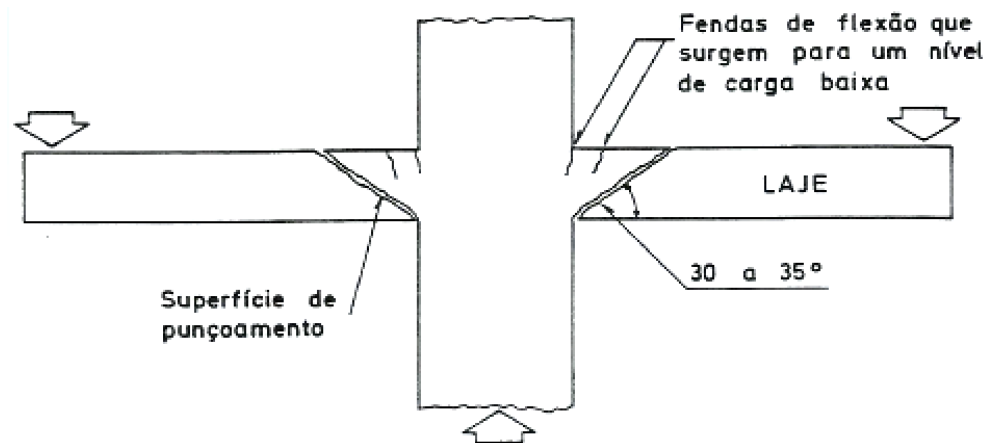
Mecanismo de rotura por punçoamento de um pavimento de laje [B16]
